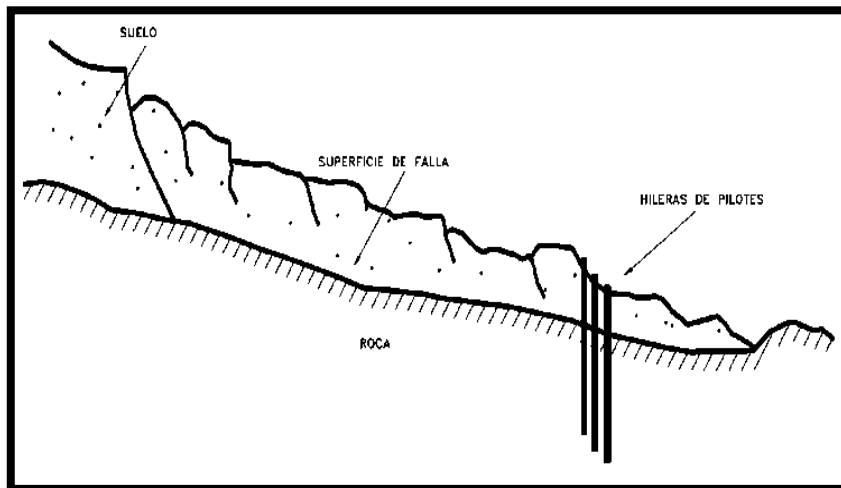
Uso de pilotes para estabilizar deslizamientos (Zaruba & Mencl, 1982).
